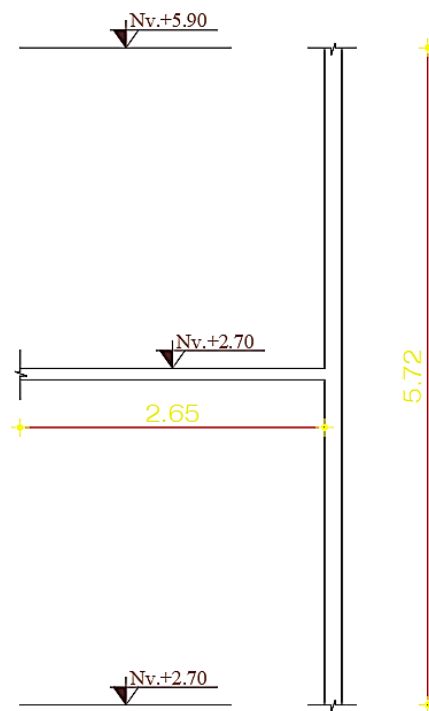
Sistema estructural y determinación de conexión según detalle de vigas y columnas.
